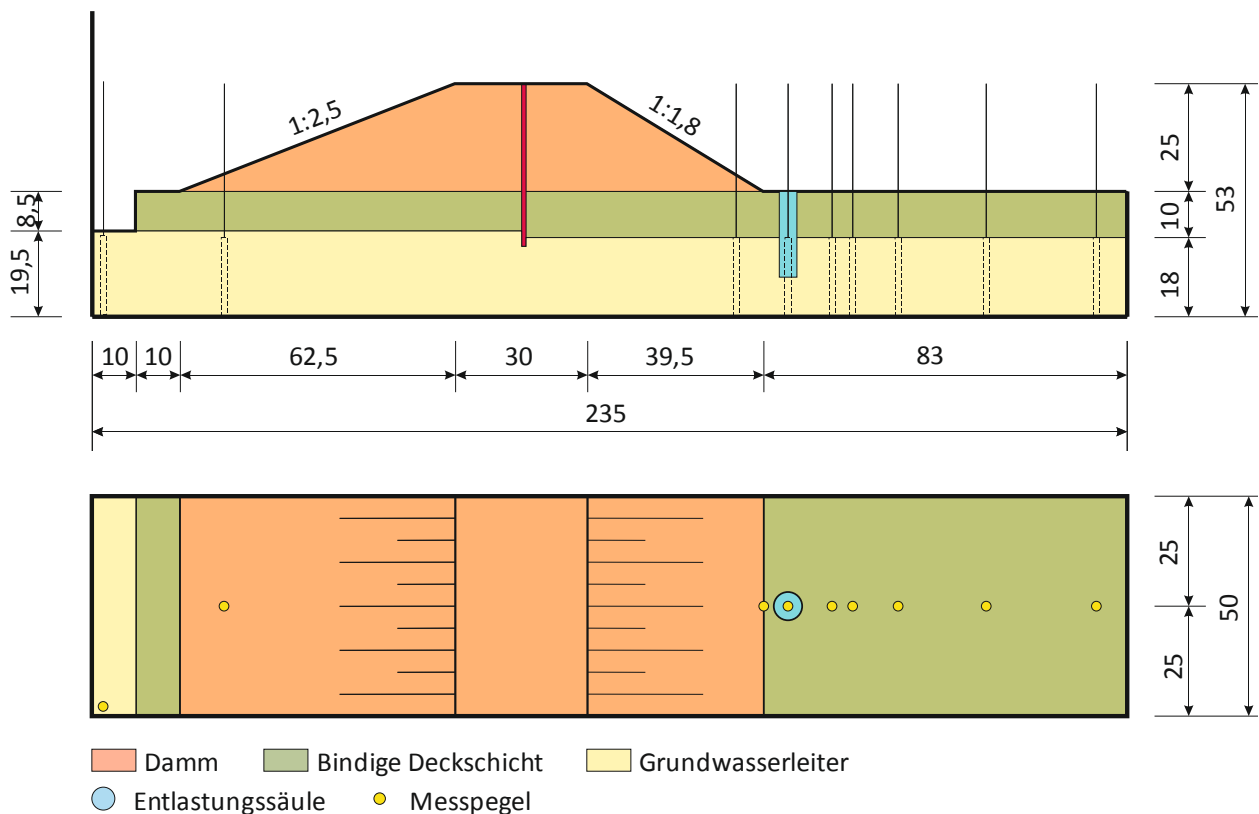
Das kleinmaßstäbliche Dammmodell - Schnitt und Grundriss (Bemaßung in cm).
